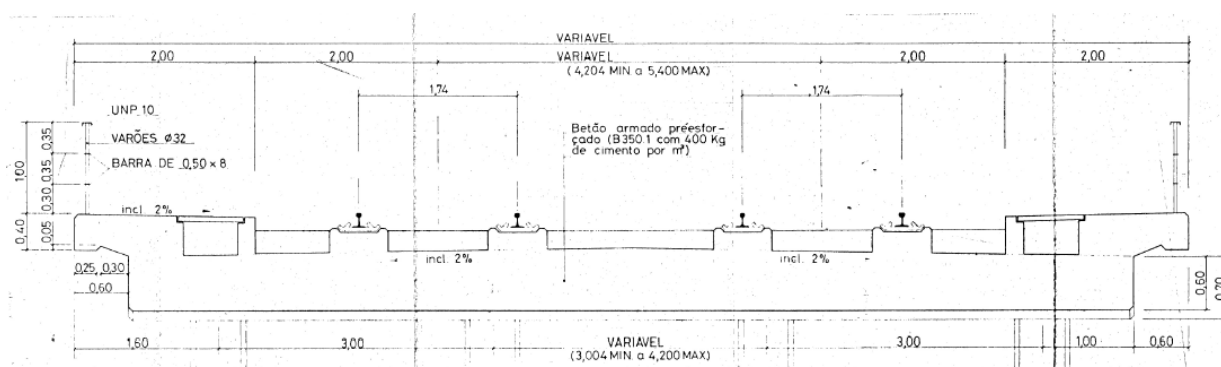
Secção transversal do tabuleiro do viaduto existente
